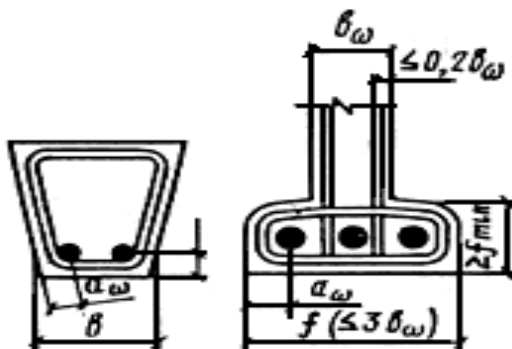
Армирование балок и расстояния до оси арматуры
